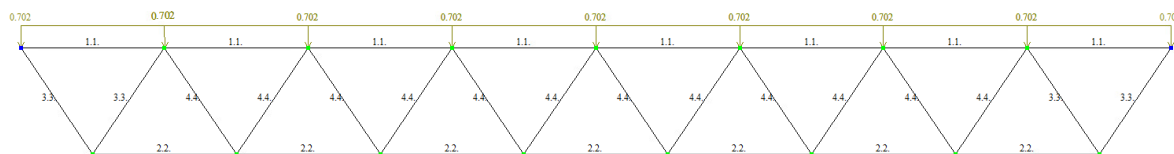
Загрузка фермы от постоянной длительной нагрузки
